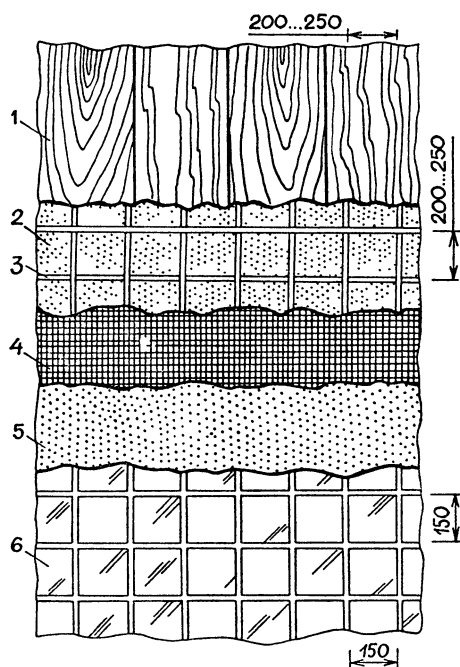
Подготовка деревянной перегородки под облицовывание керамической плиткой:
